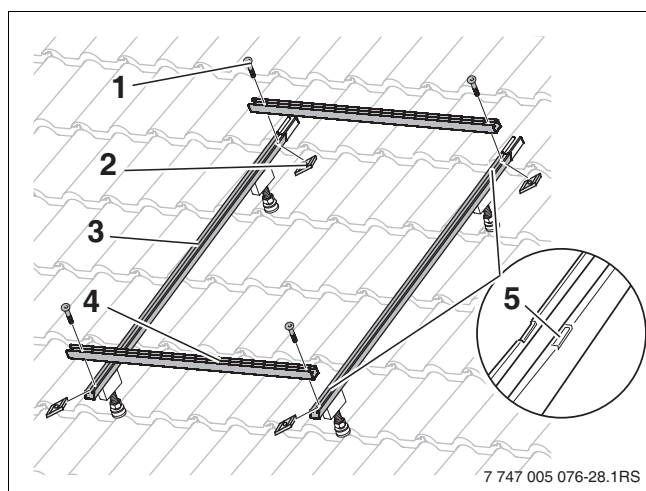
Fijar el perfil de cubierta plana/tejado inclinado al perfil del captador
